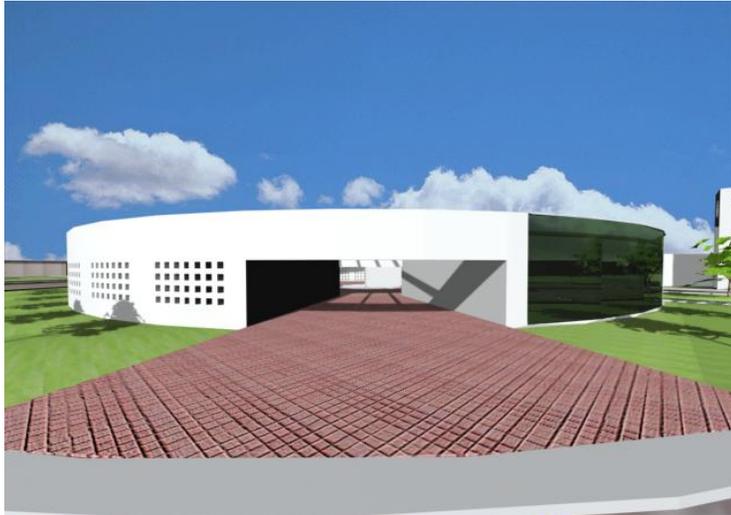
IMAGEN: ACCESO A VELATORIO (FACHADA SUR)
